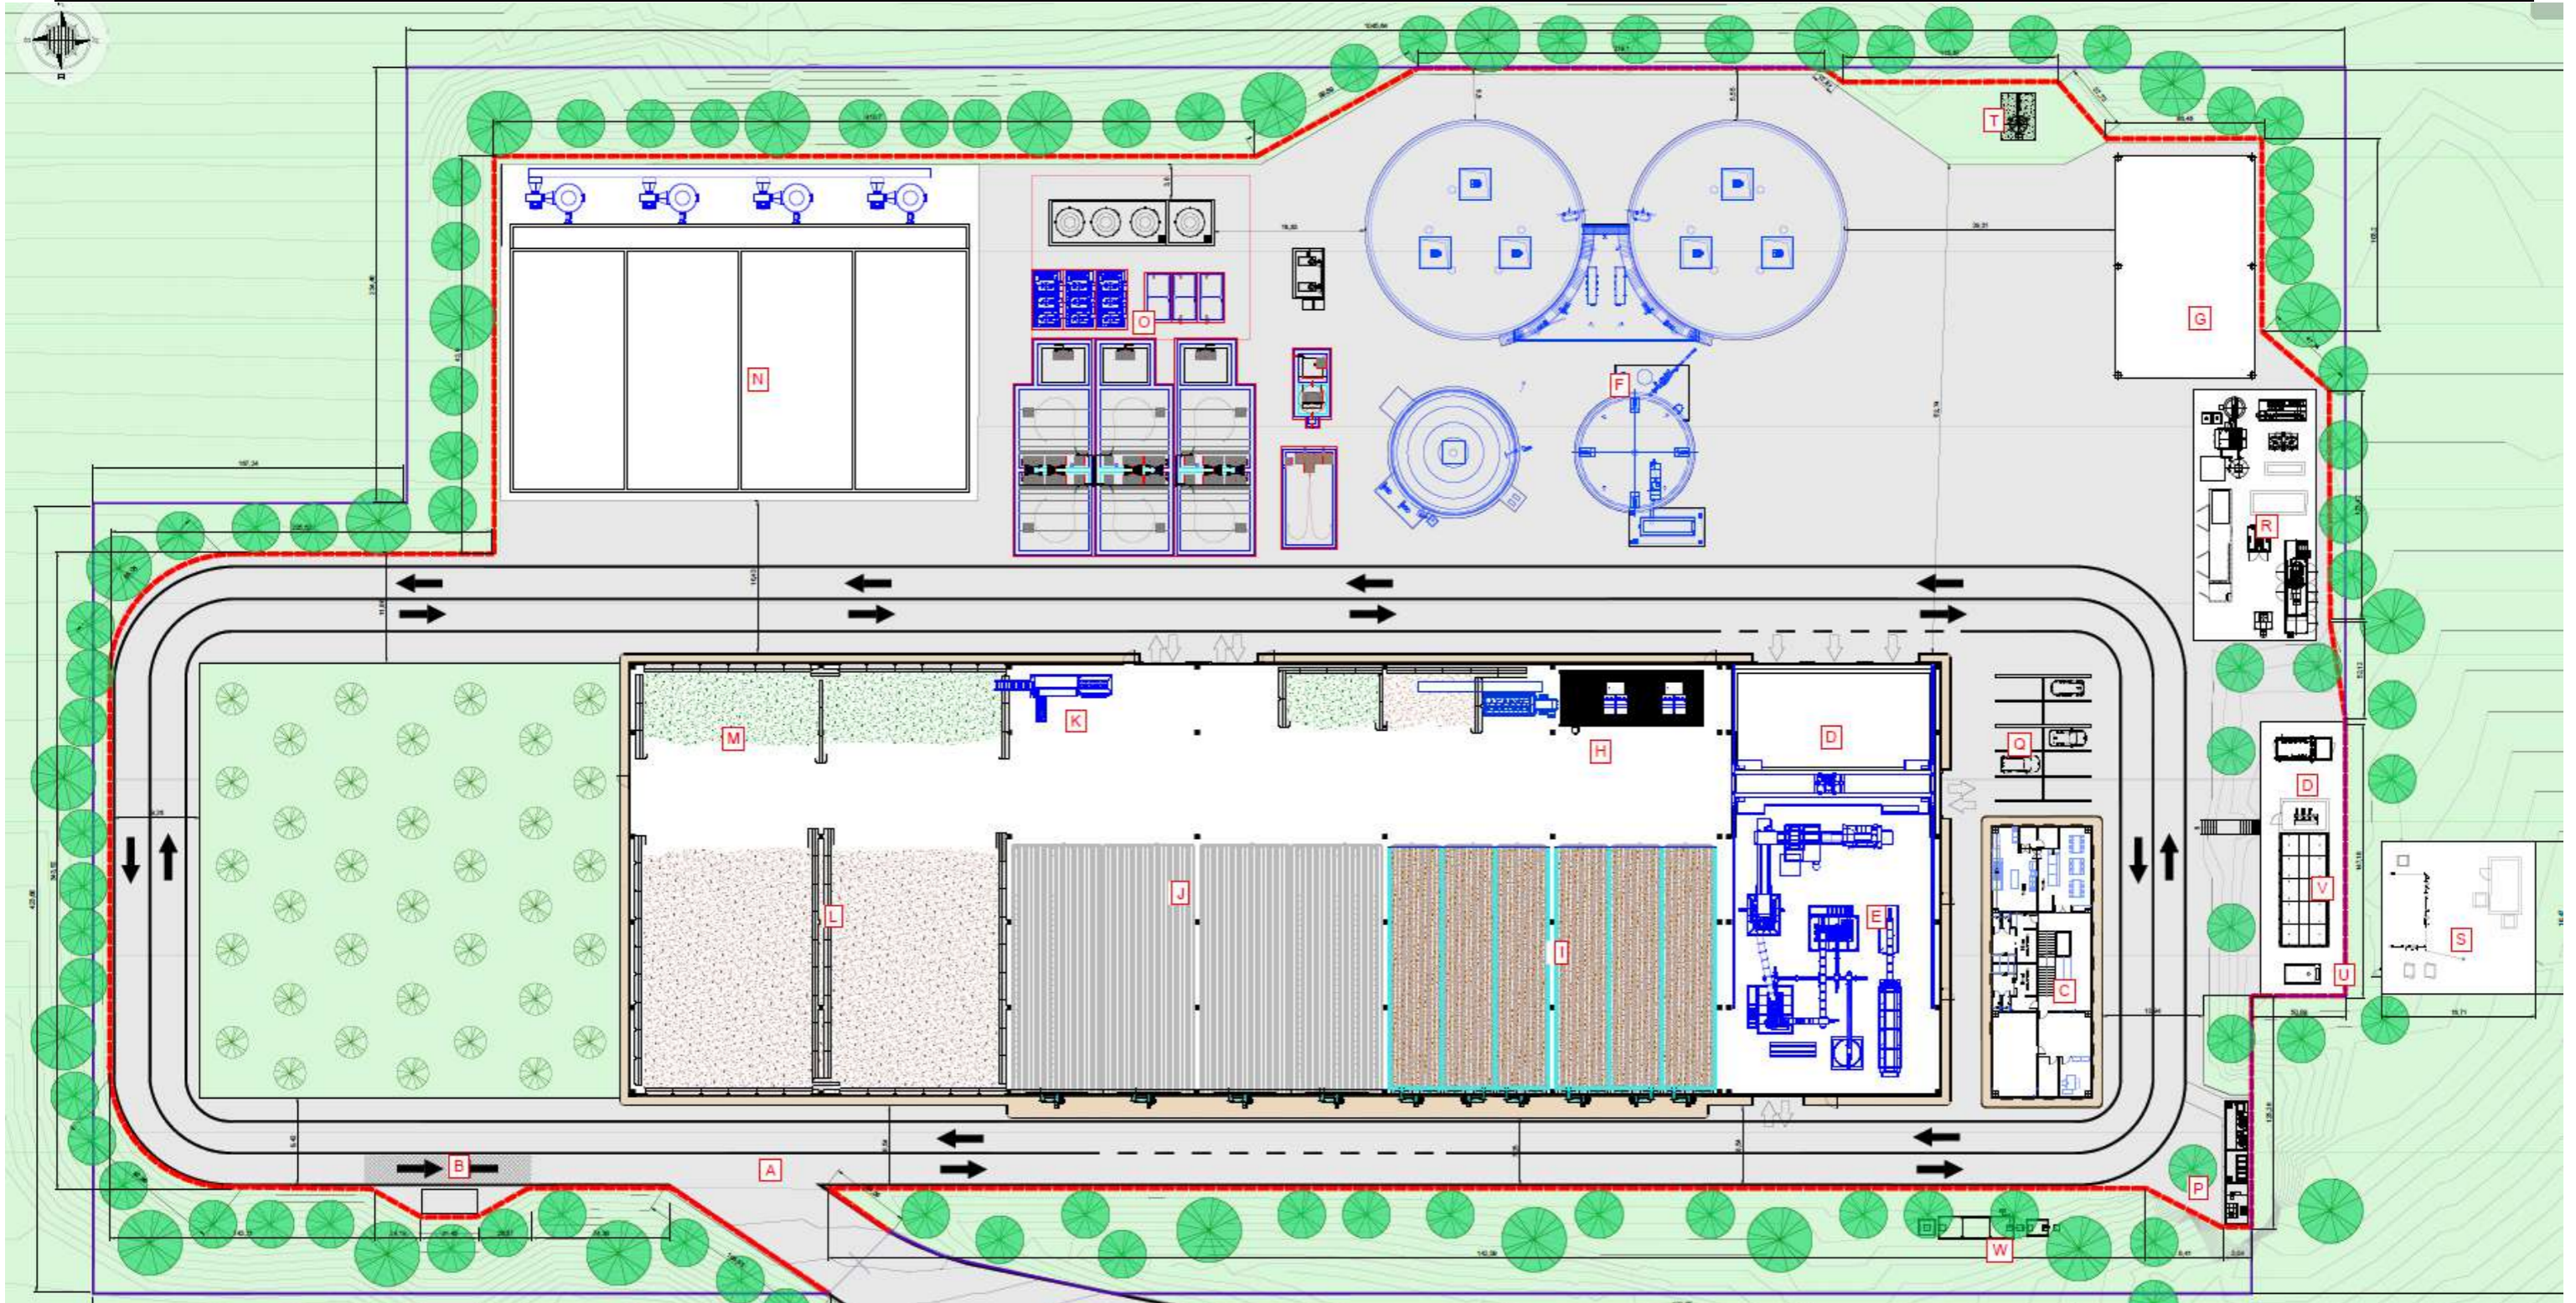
ESE.EGR.GEN.001 – Planimetria generale di progetto
